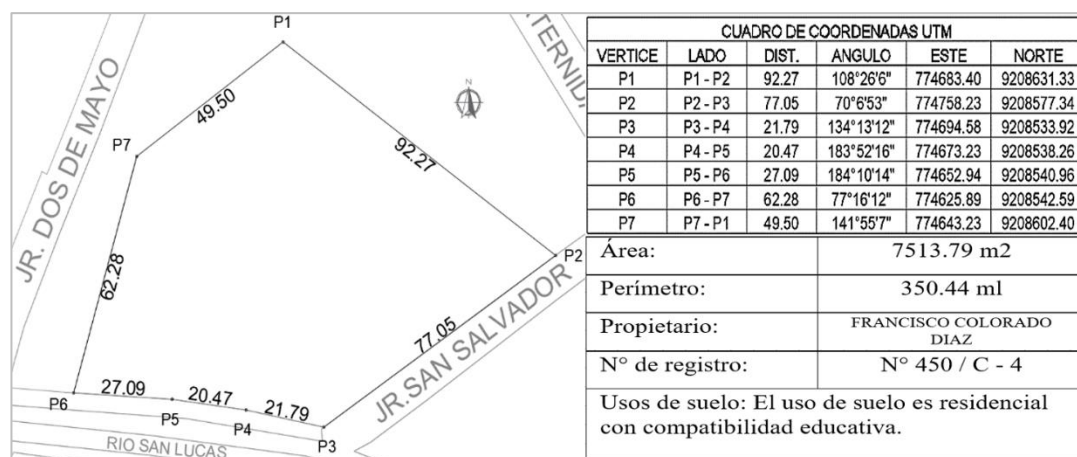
Plano de ubicación del proyecto arquitectónico. Fuente: Elaboración Propia sobre la base del plano catastral de Cajamarca.
